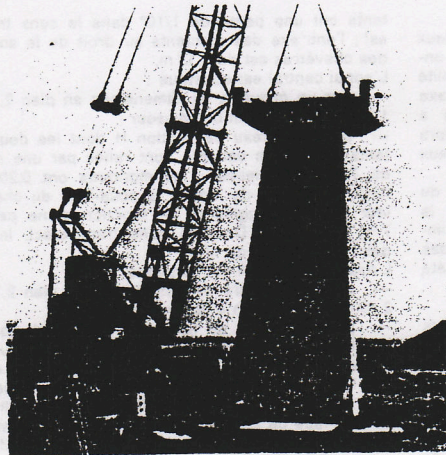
Lévage d'un poteau (Photo Baranger et Cie)
